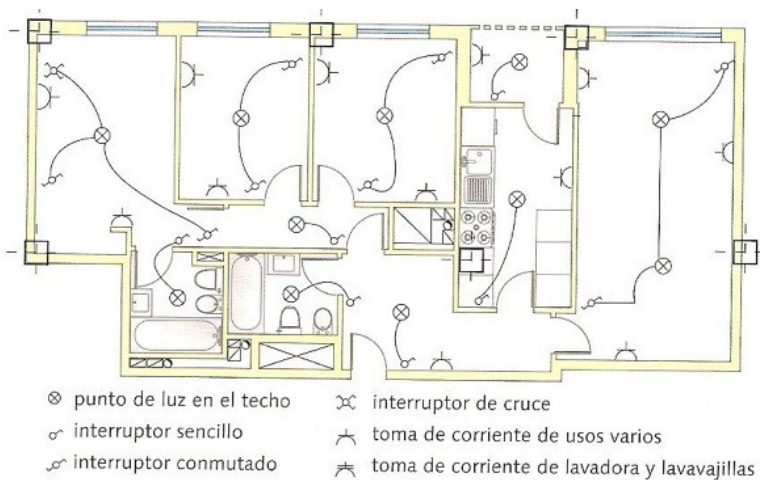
plano de plantas de viviendas unifamiliar equipadas. Fuente: www.arquitectuba.com
